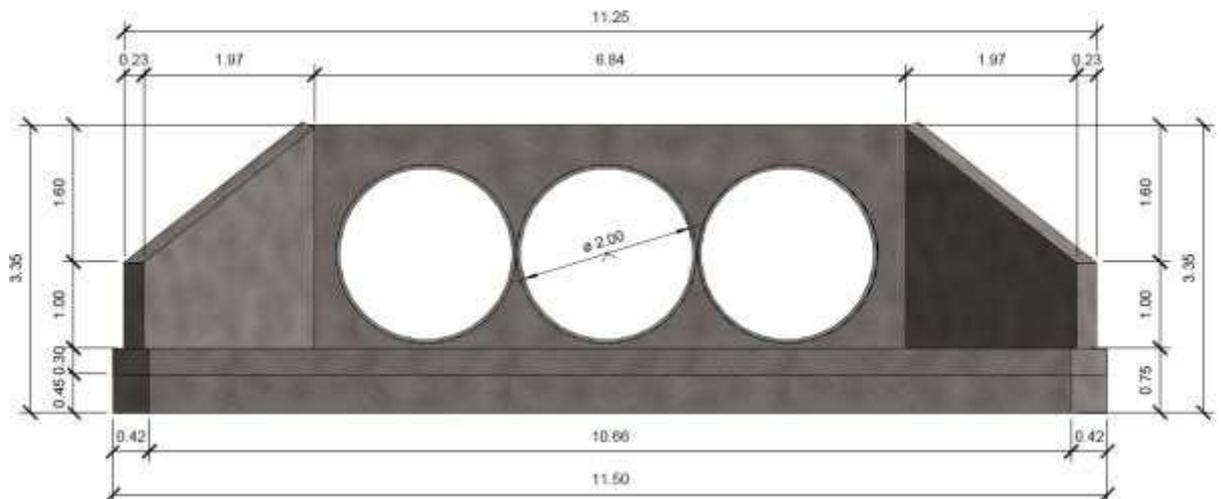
Diseño de Alcantarilla (Vista Frontal)
